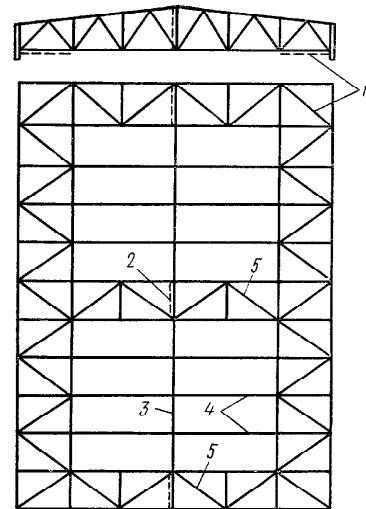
Горизонтальные и вертикальные связи между стропильными фермами:
